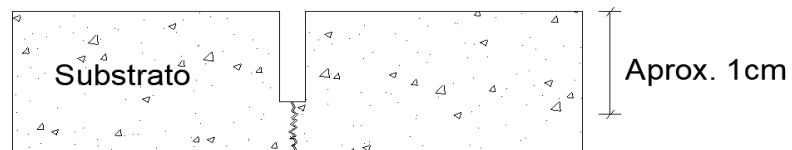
Corte esquemático da abertura das fissuras do pavimento
